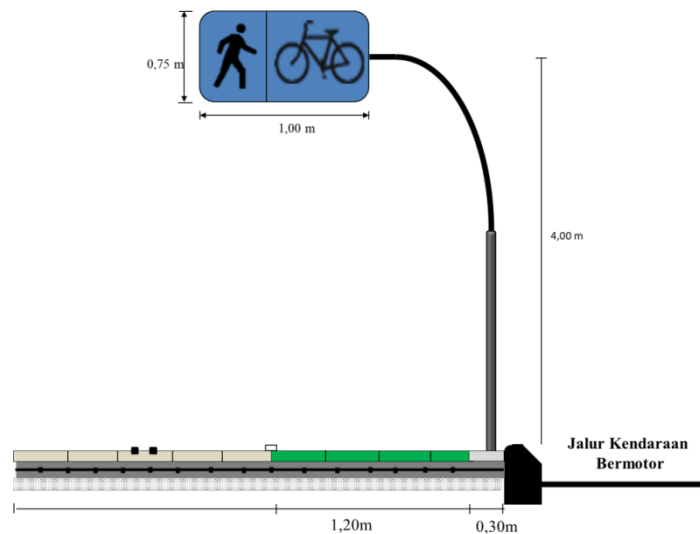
Rambu petunjuk lajur sepeda di depan
